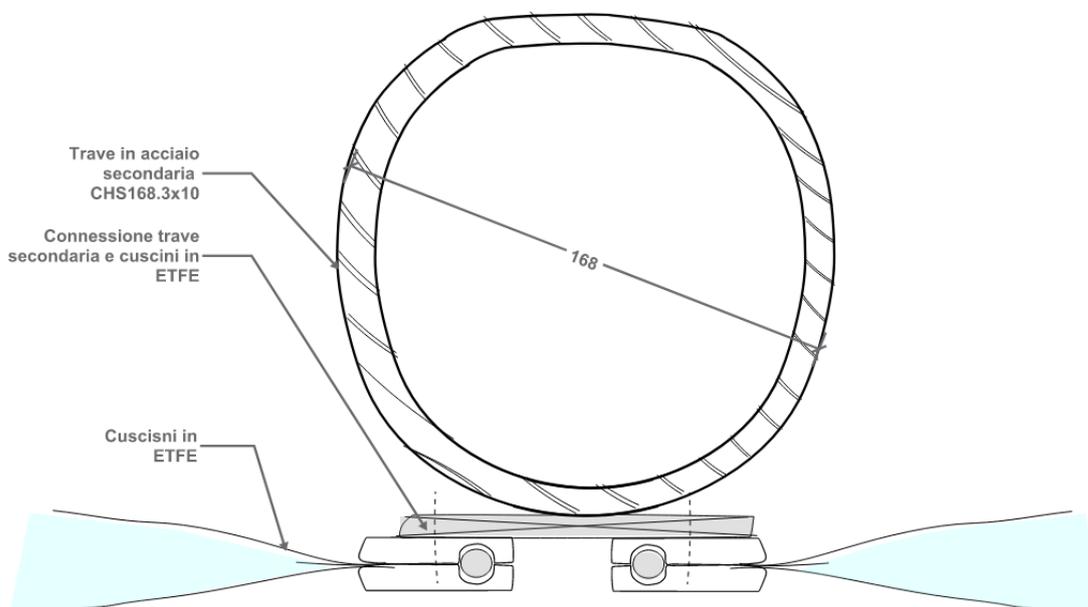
Giunto di connessione tra cuscini in ETFE e struttura secondaria in acciaio.
